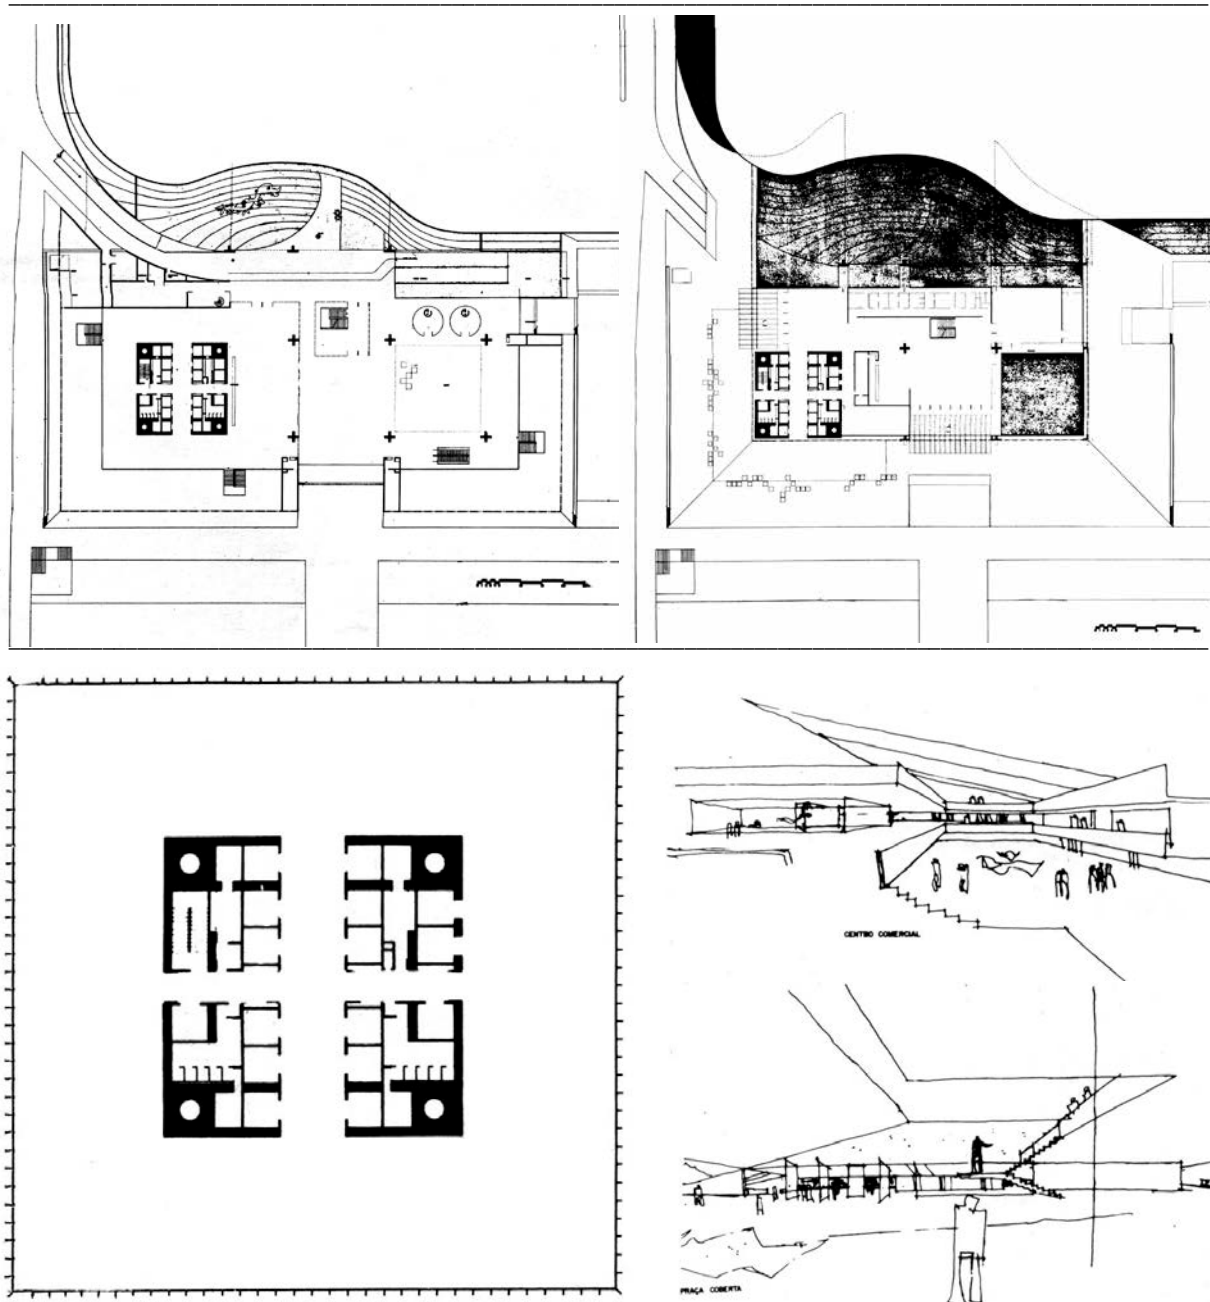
planta pav. térreo; Fig. 768: planta mezanino; Fig. 769: planta pavimento tipo. Fig. 770: croquis hall de acesso.
